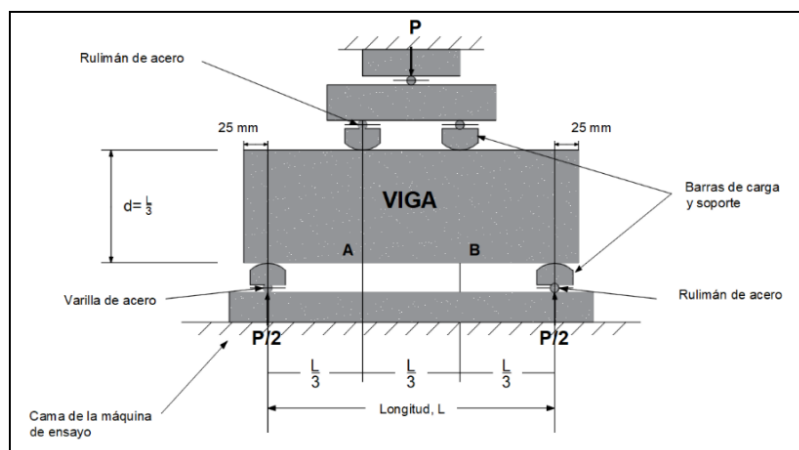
Esquema de la configuración del ensayo a flexión de vigas de hormigón armado.
